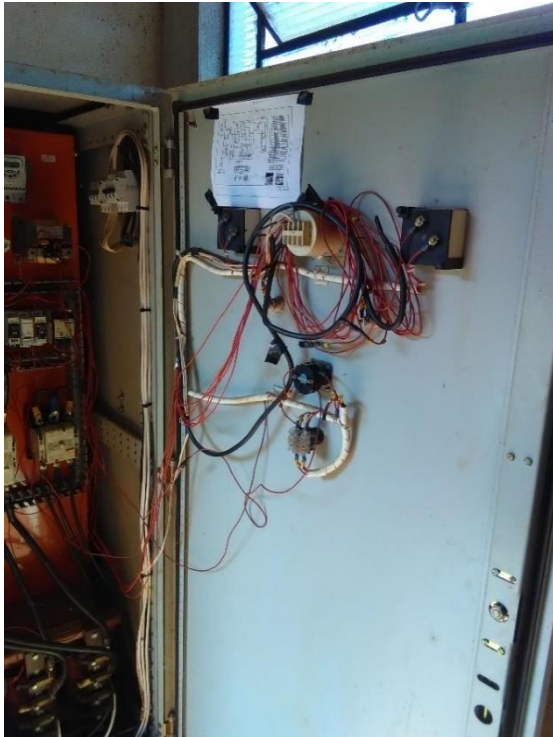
Quadro de comando da elevatória do poço Bela Vista
